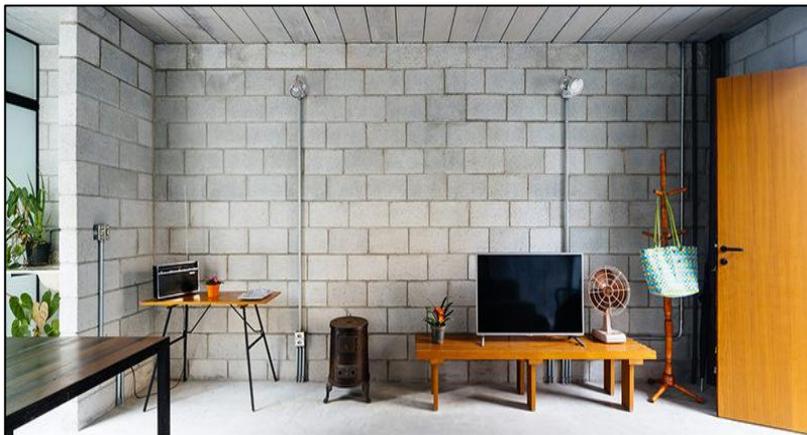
Paredes de Estabilidad Estructural a la Losa
